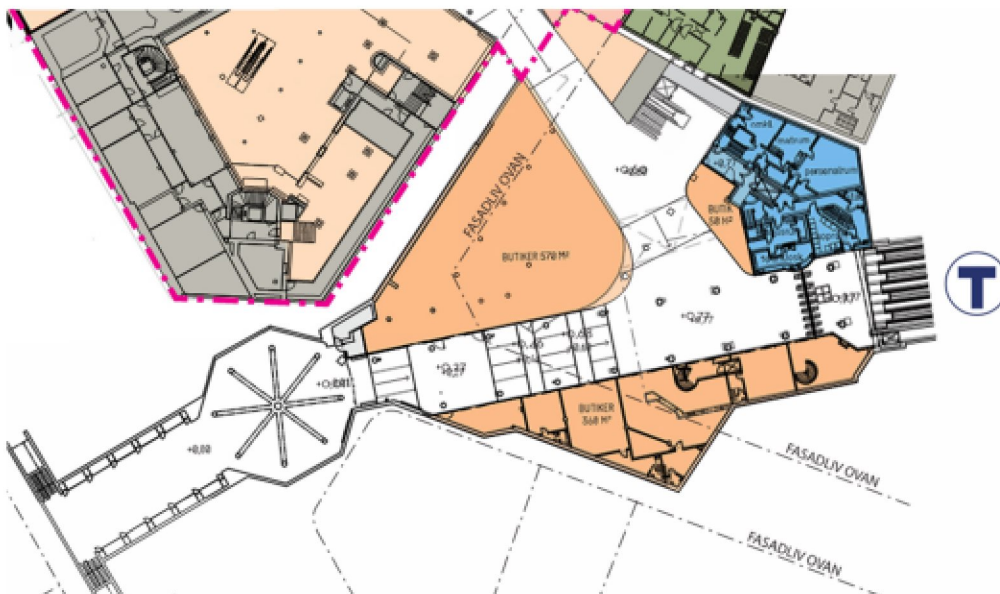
Planlösning samt utrymningsvägar (gröna pilar), befintligt utförande Östermalmstorg Södra, plan 5 (motsv. plan -1 för kv. Sperlingens backe)
